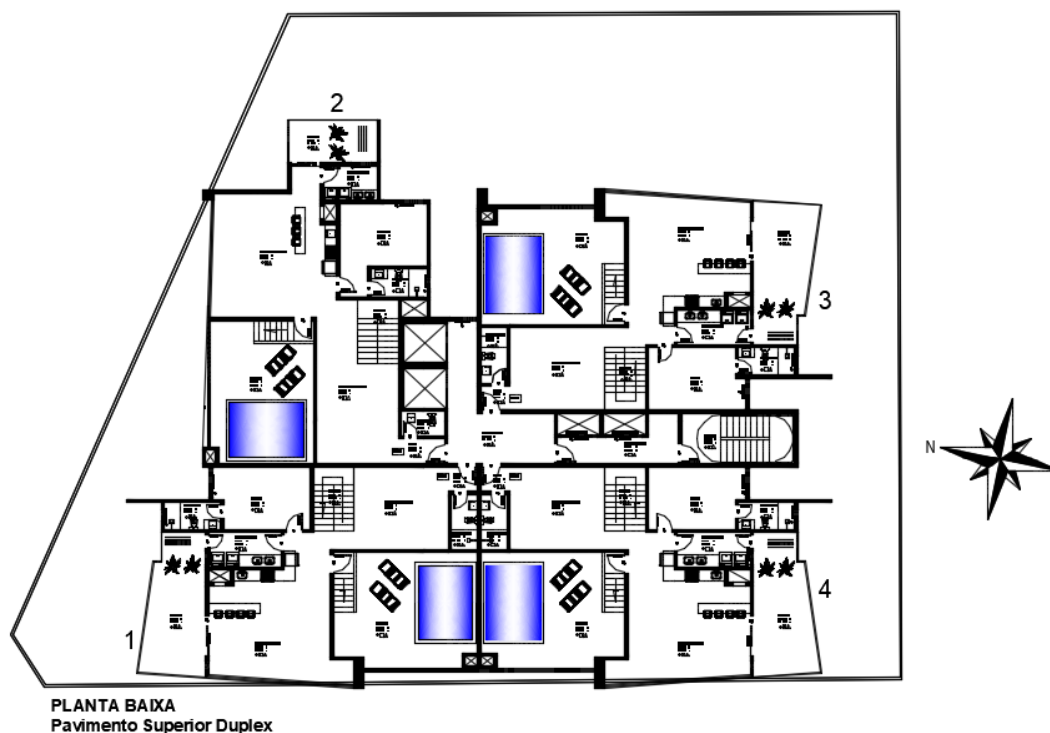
Projeto Arquitetônico – Pavimento DUPLEX SUPERIOR
